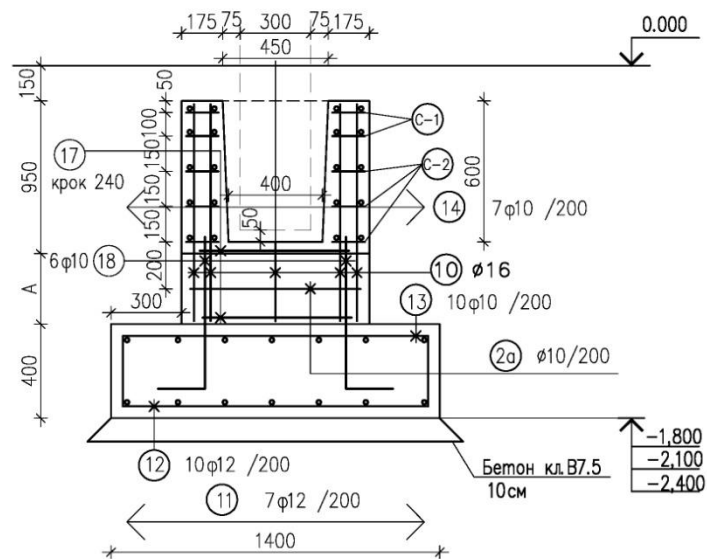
Конструкція і схема армування монолітного фундаменту S2 – 1
